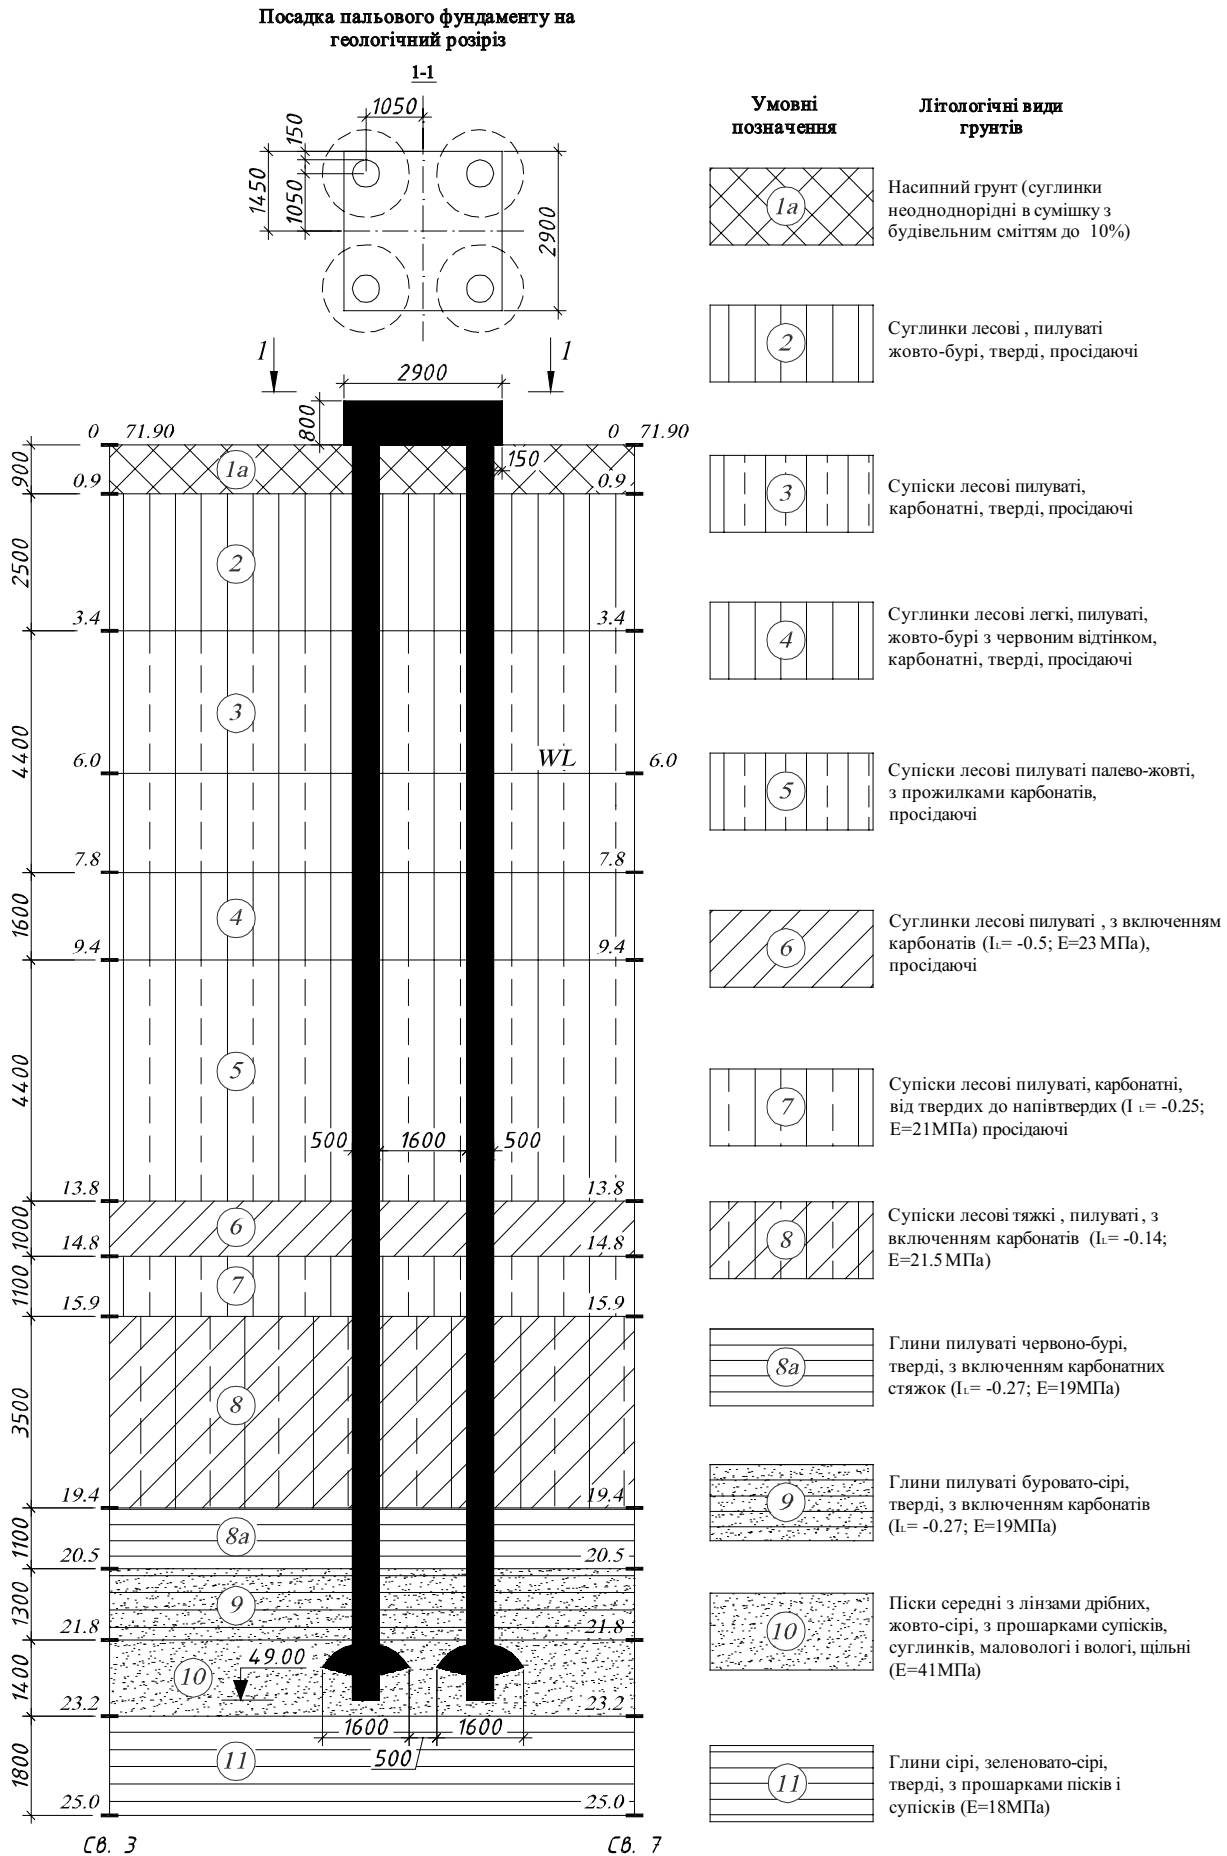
Посадка пальового фундаменту на геологічний розріз.
